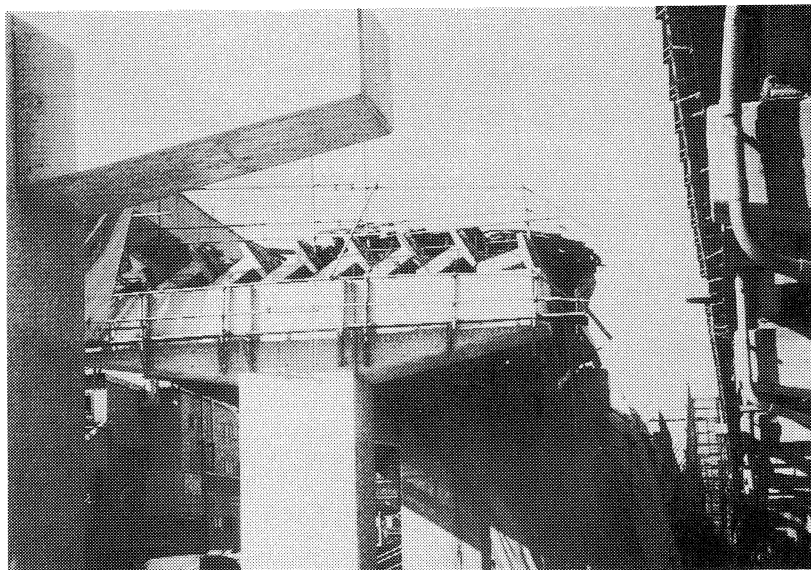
施工中の国道176号線 久代高架橋 プレテン連結T桁橋
